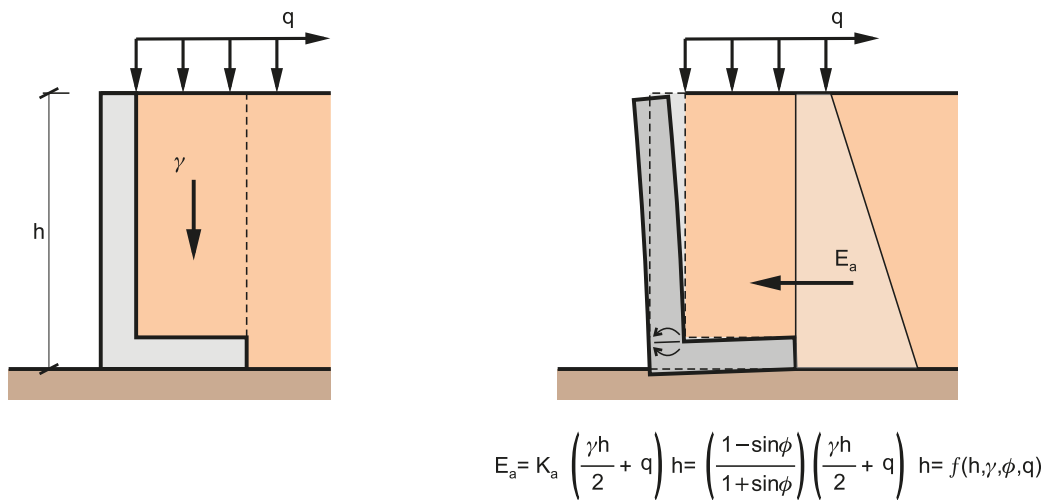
Acciones y efectos de las acciones en un muro de gravedad
